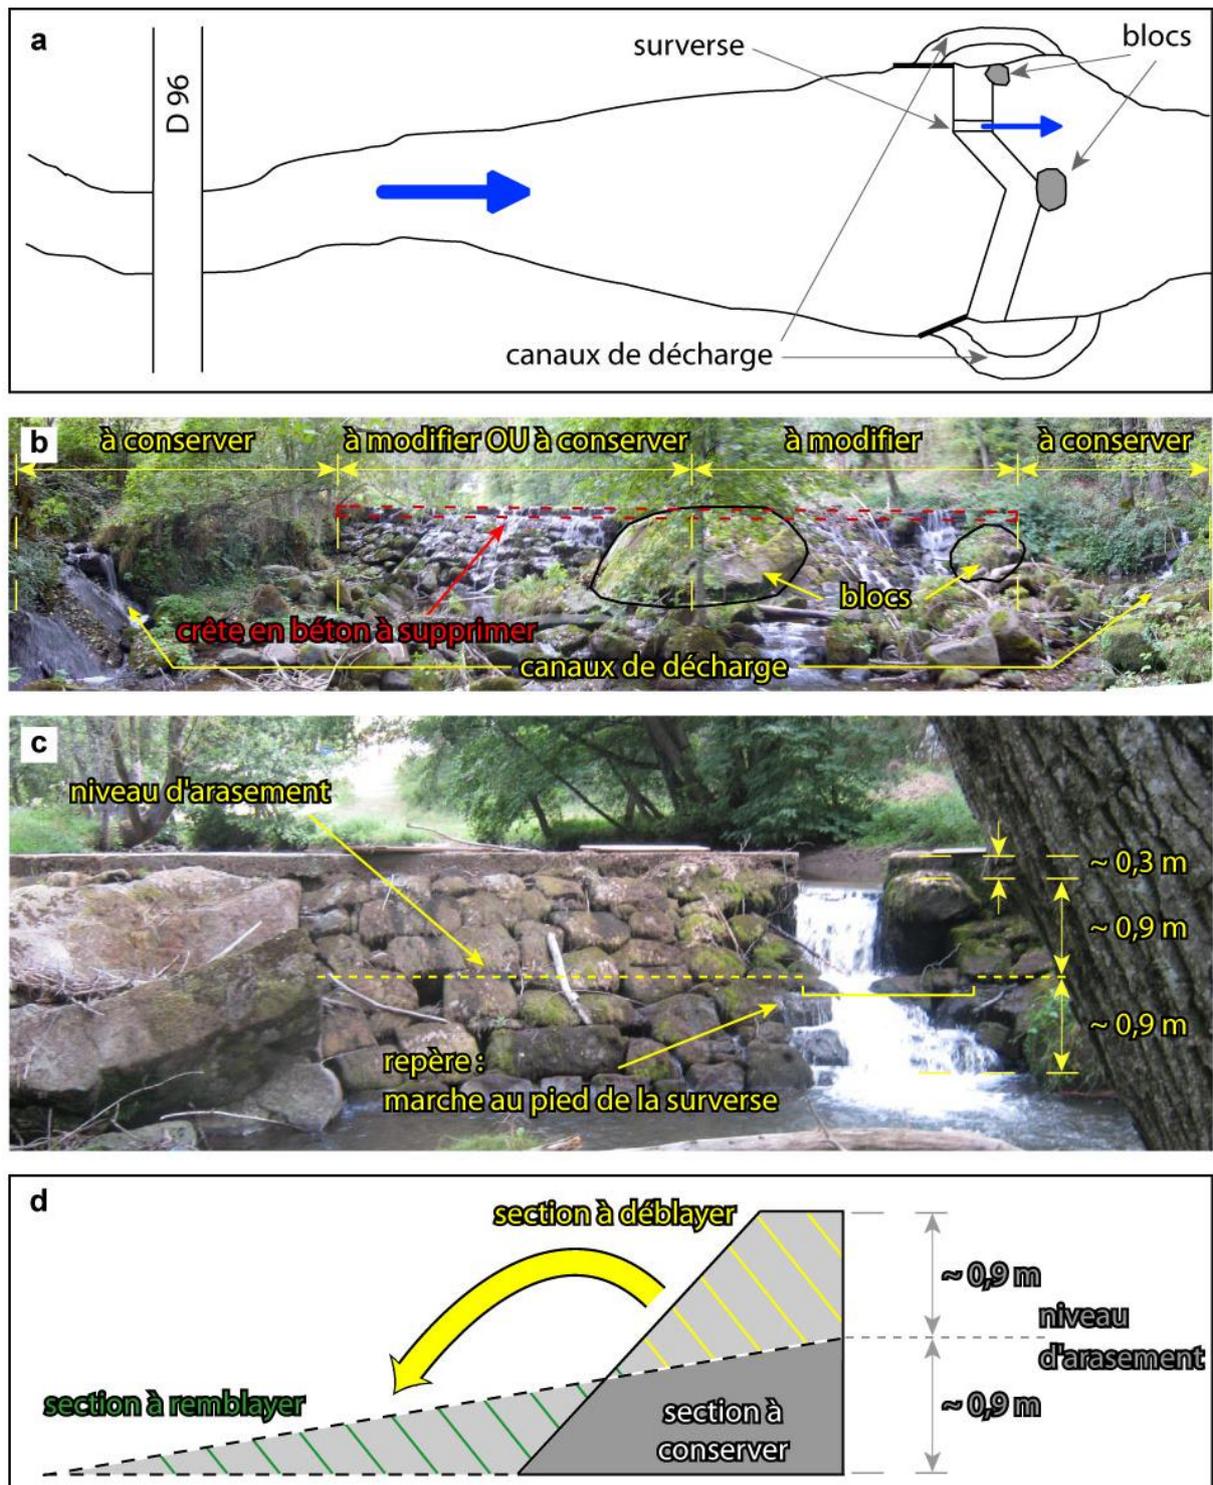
interventions sur la chaussée de de Moulibez : arasement de l'ouvrage et aménagement d'une rampe
